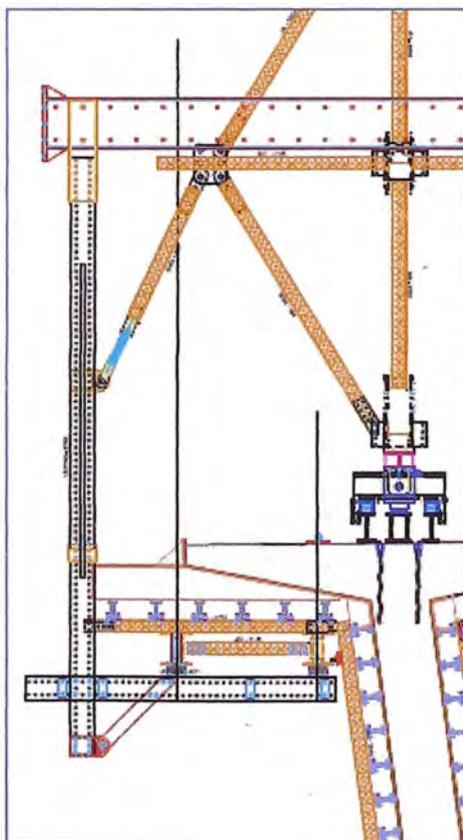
Encofrado Exterior - Fuente: Elaboración Propia
